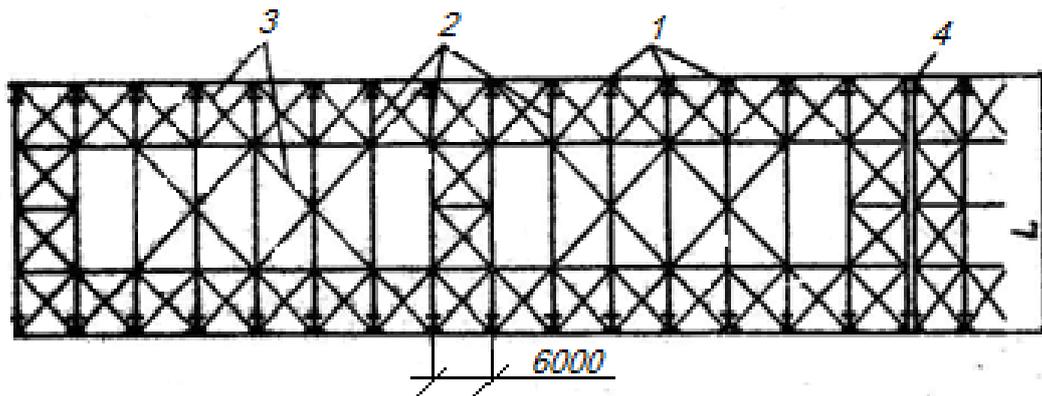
Связи по нижним поясам ферм в крановых цехах:
